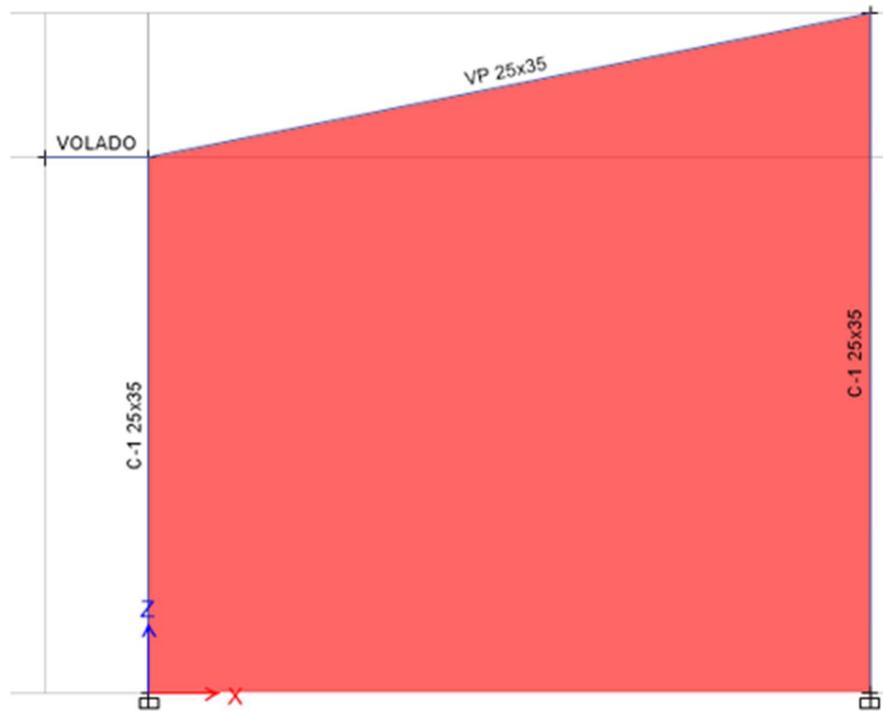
ETABS, Secciones de Vigas y Columnas en Pórticos Principales.
